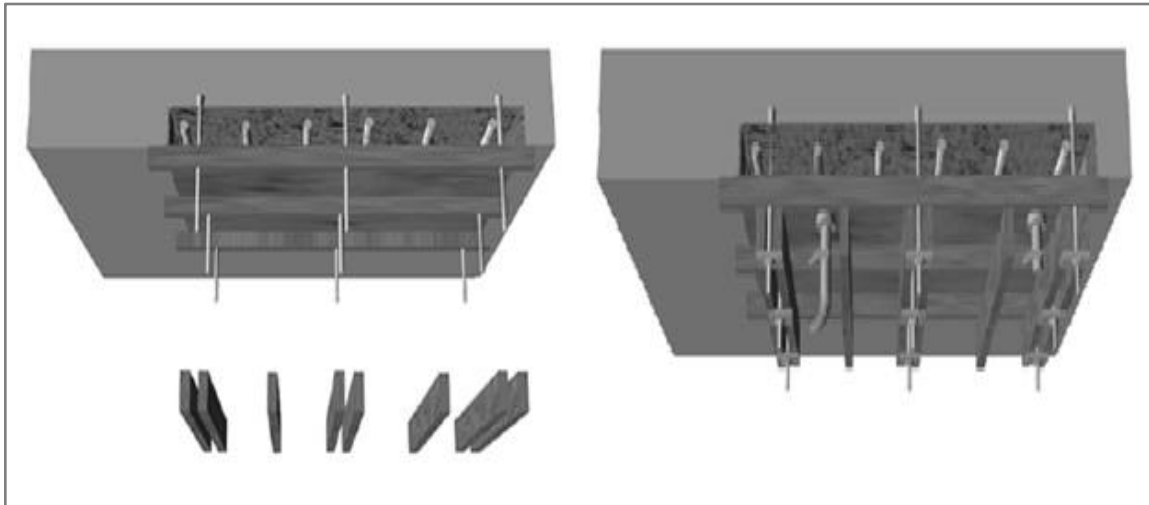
Encofrado de losa. Fuente: (ACI RAP-5, 2011).
